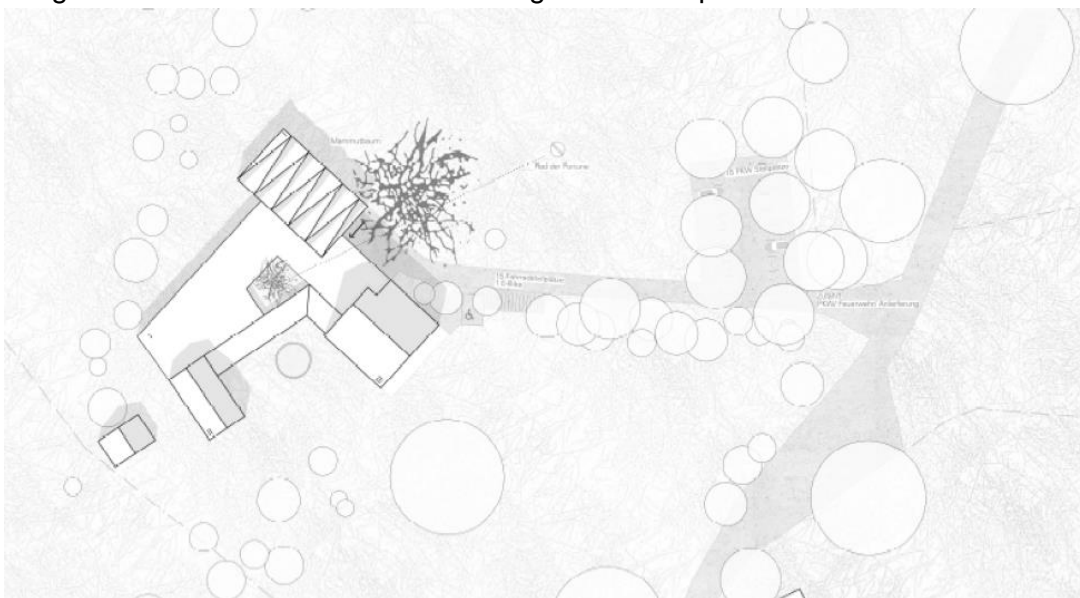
Wettbewerbsentwurf des Büros Meck Architekten GmbH
